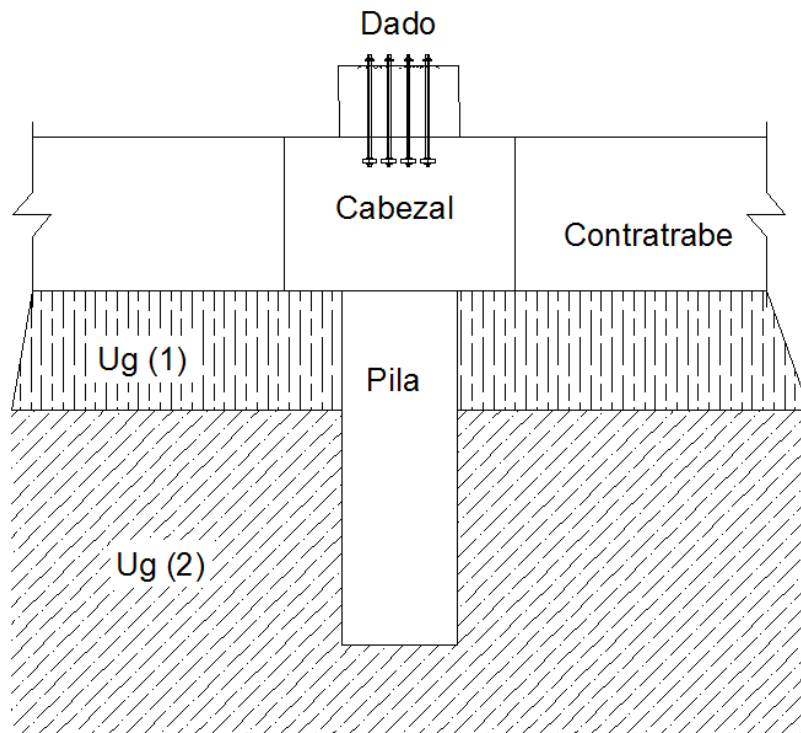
Detalle de unión entre pila, cabezal, contratrabe y dado de concreto.
